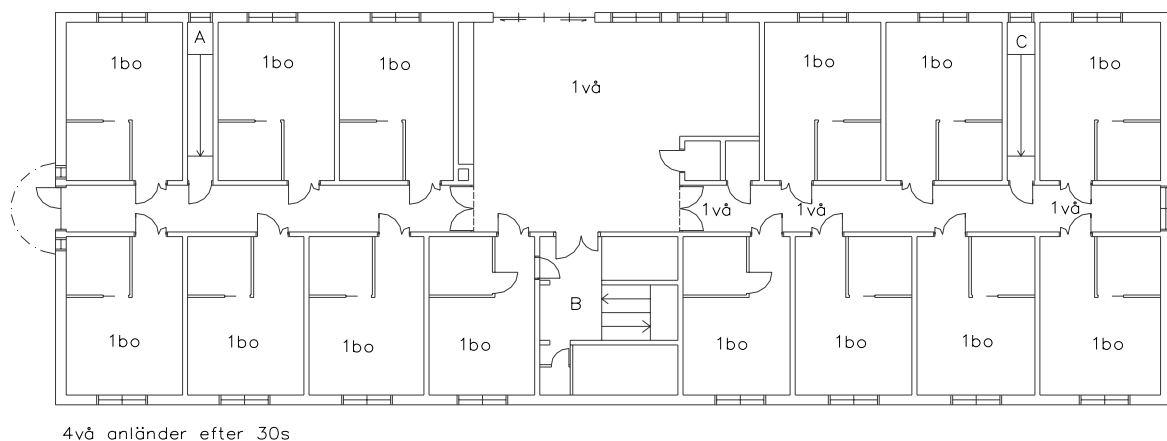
Utgångsläge för utrymning Smedjan, plan 2 under dagtid.
